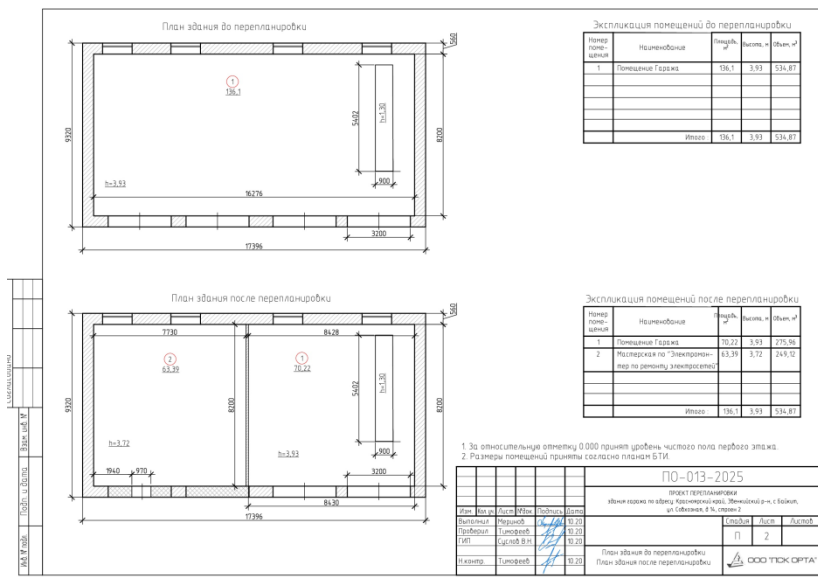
План здания до перепланировки, план здания после перепланировки
